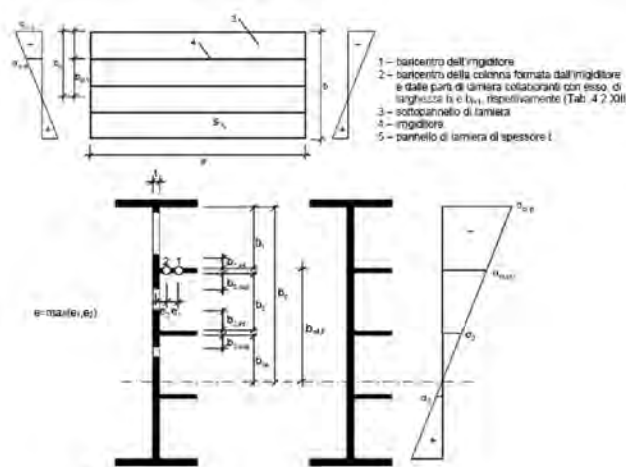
Lastra irrigidita pressoinflessa
